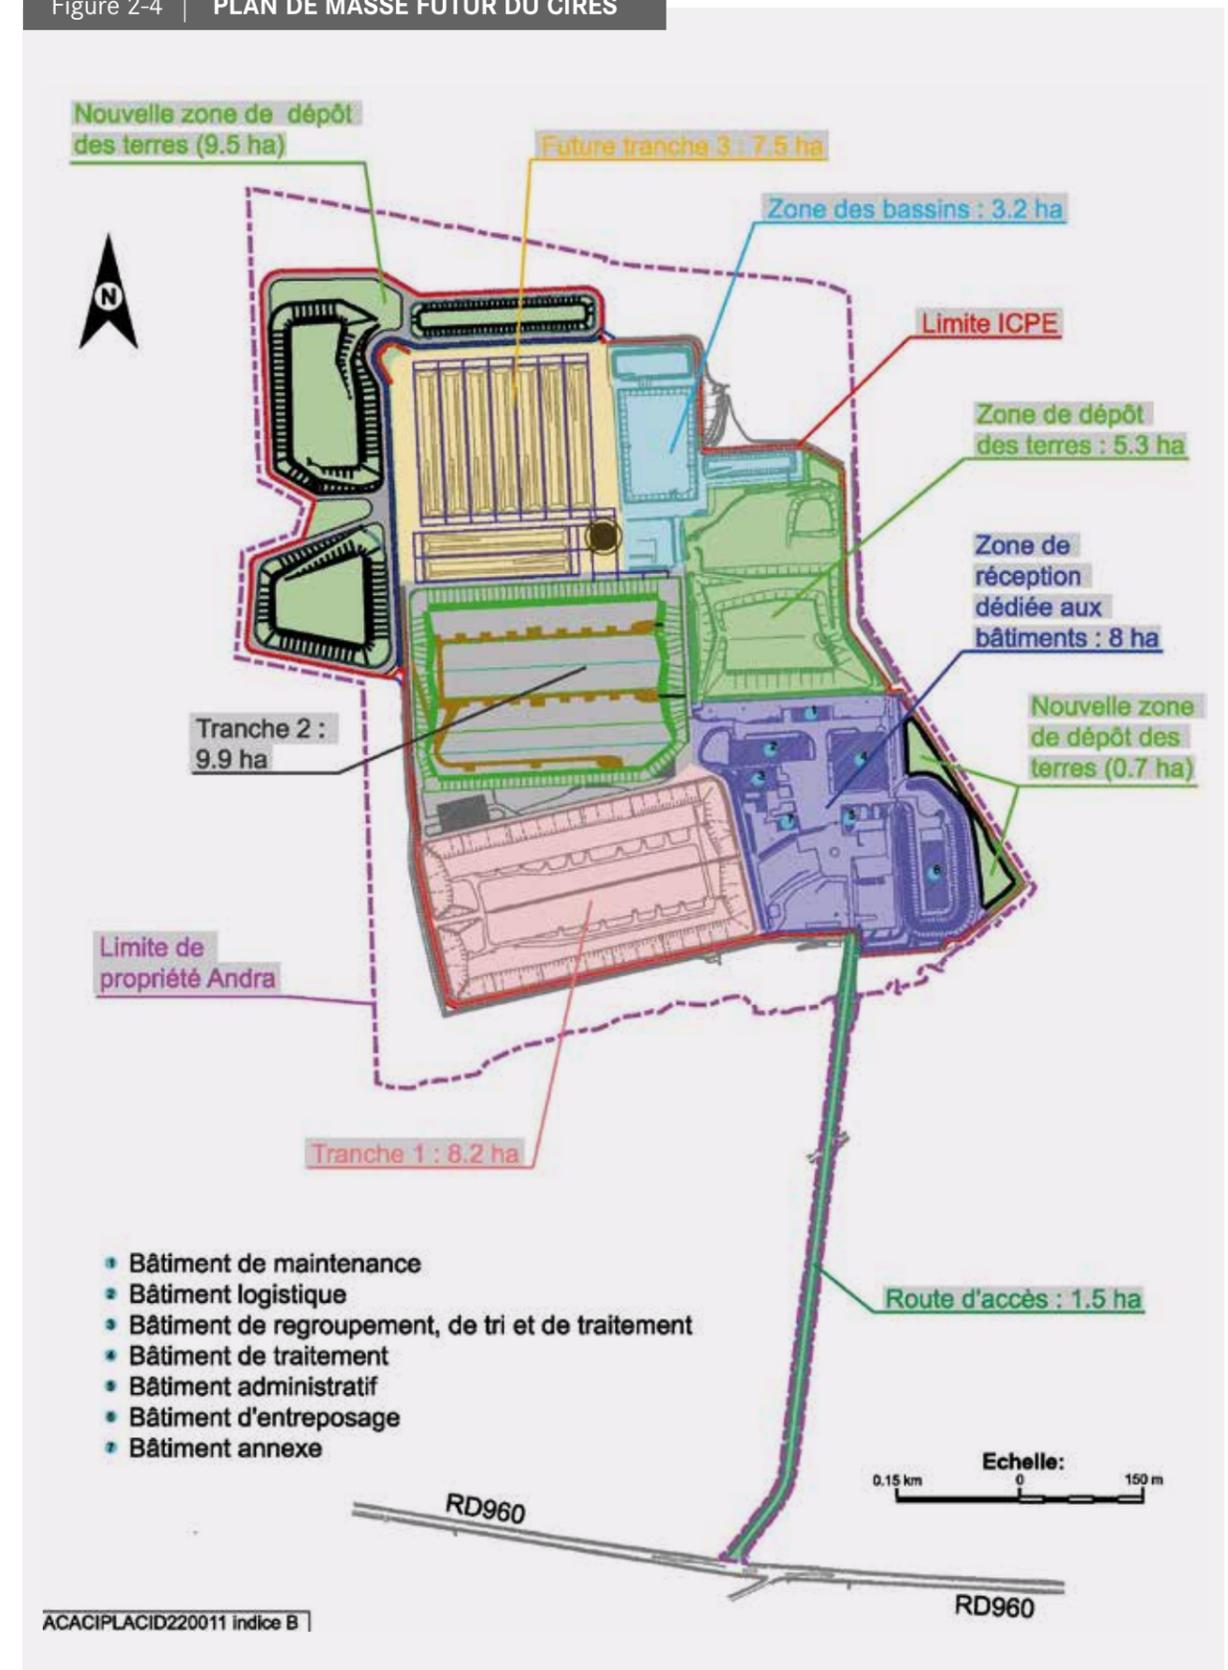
| PLAN DE MASSE FUTUR DU CIRES
